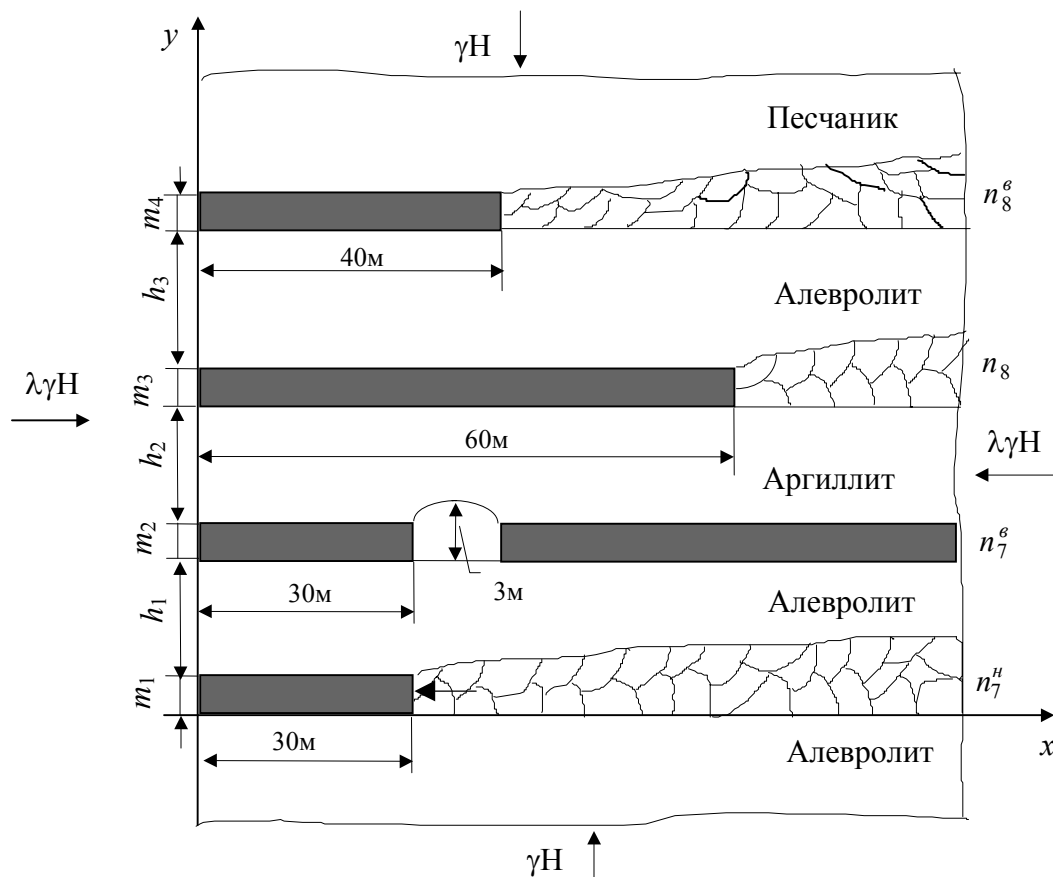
Расчетная схема к определению НДС вокруг выработки
